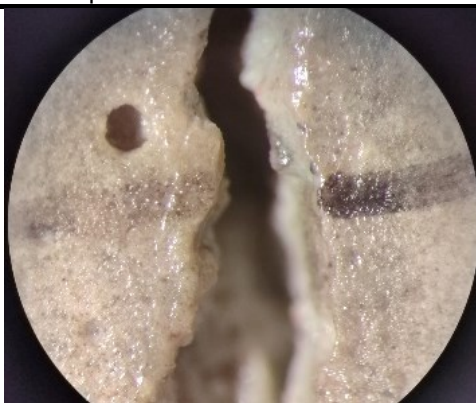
Medición de fisuras con el fisuometro.
